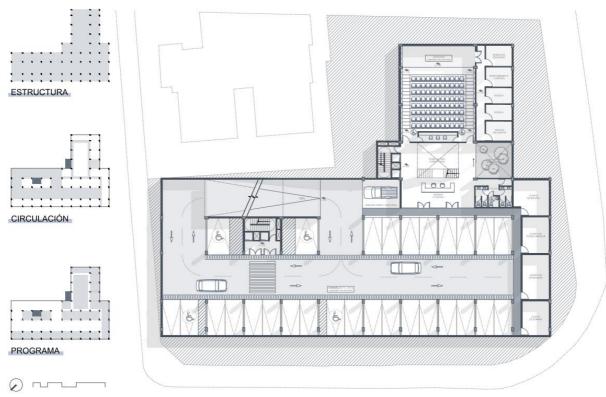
Planimetría: Planta Subsuelo 1 (N-3,00)
